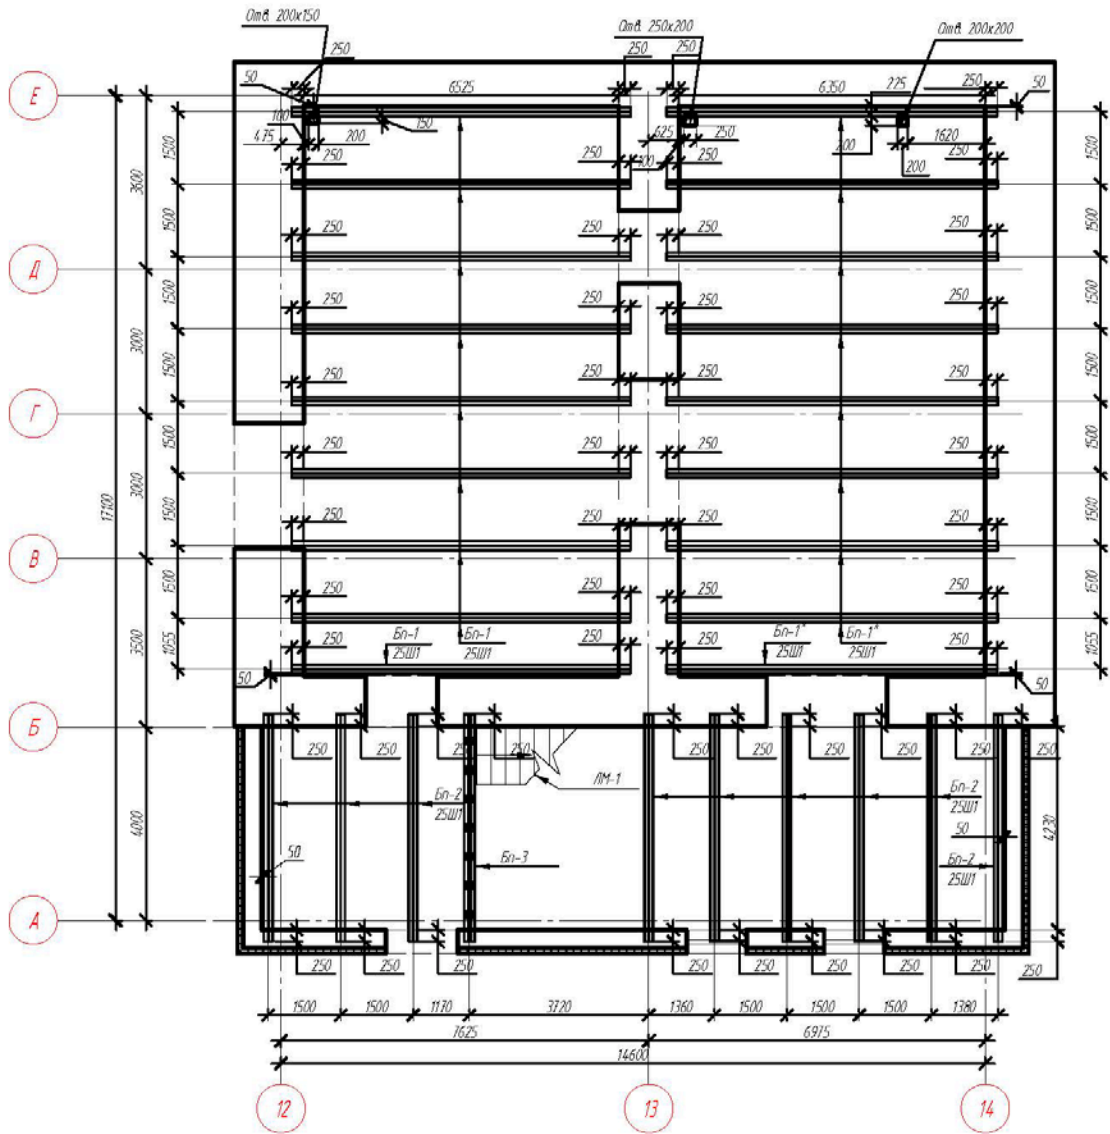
Схема перекрытия на отметке 0,000
